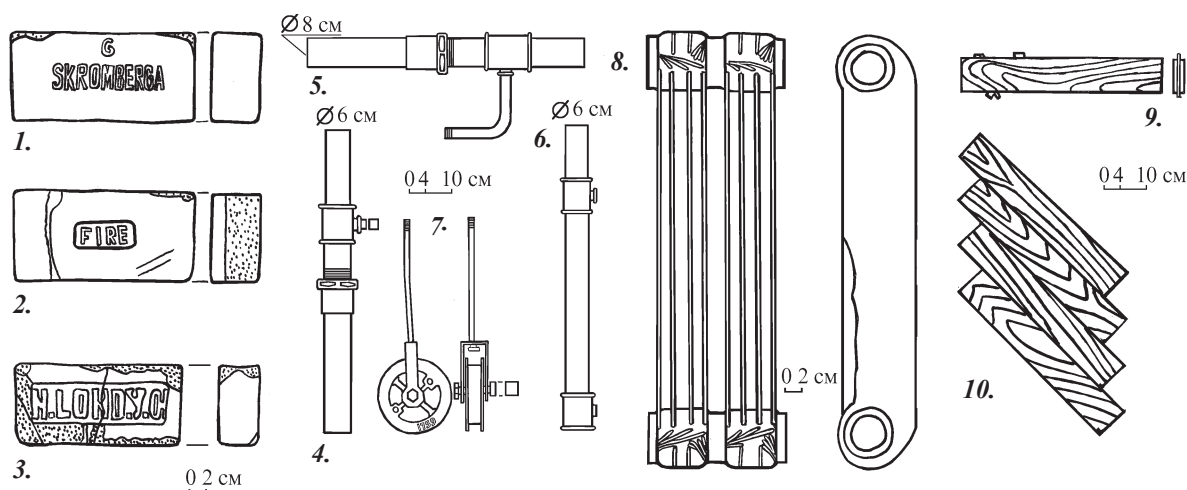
Образцы 1—3 — котельного шамотного кирпича; 4—6 — трубы; 7 — маховика; 8 — звеньев радиатора батареи парового отопления; 9, 10 — образец доски дубового паркета и кладки паркетного пола в «ёлку». Корпус «Б»
